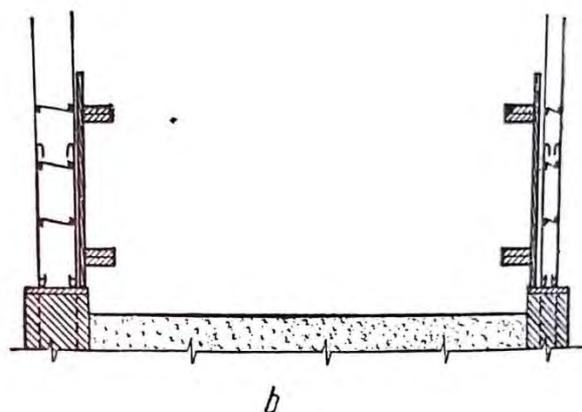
6.- Colocación de primer tramo de la armadura (1)
